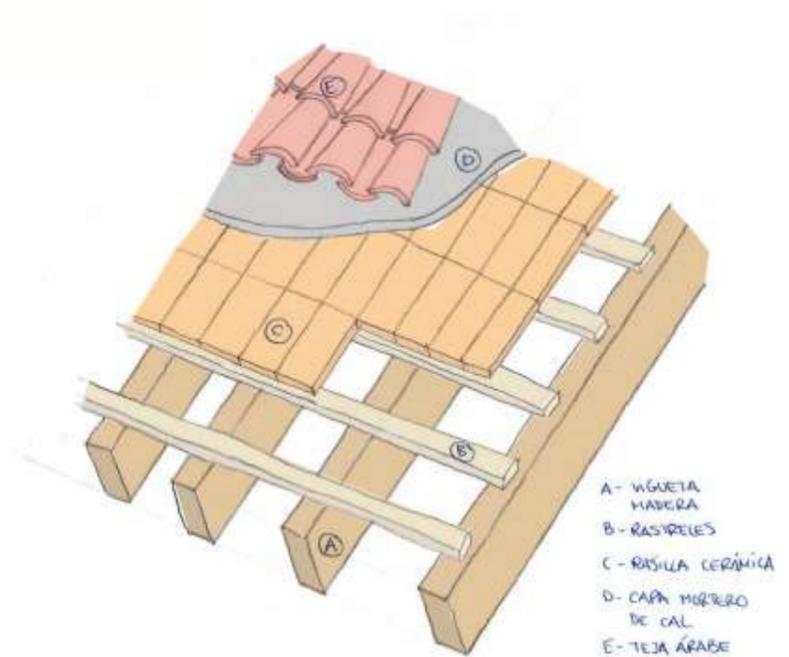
detalle cubierta de madera, TIPO 3. Elaboración propia
